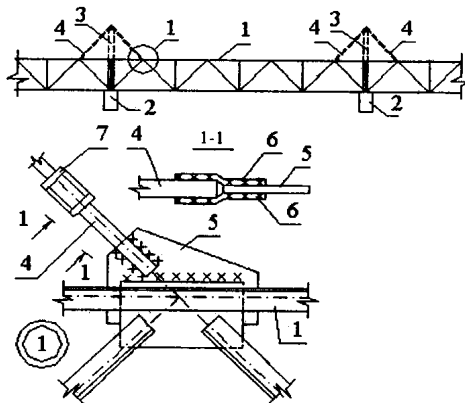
Улаштування підвісок: 1 – ферма; 2 – колони; 3 – додаткові сталеві
